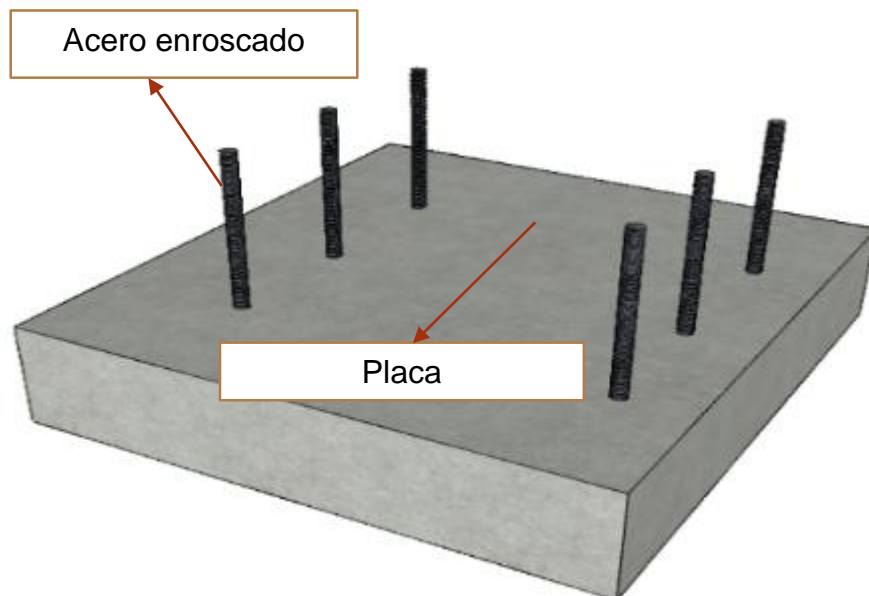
Placas de concreto aligerado con barras enroscadas de 3/8 y 1/2 respectivamente.
